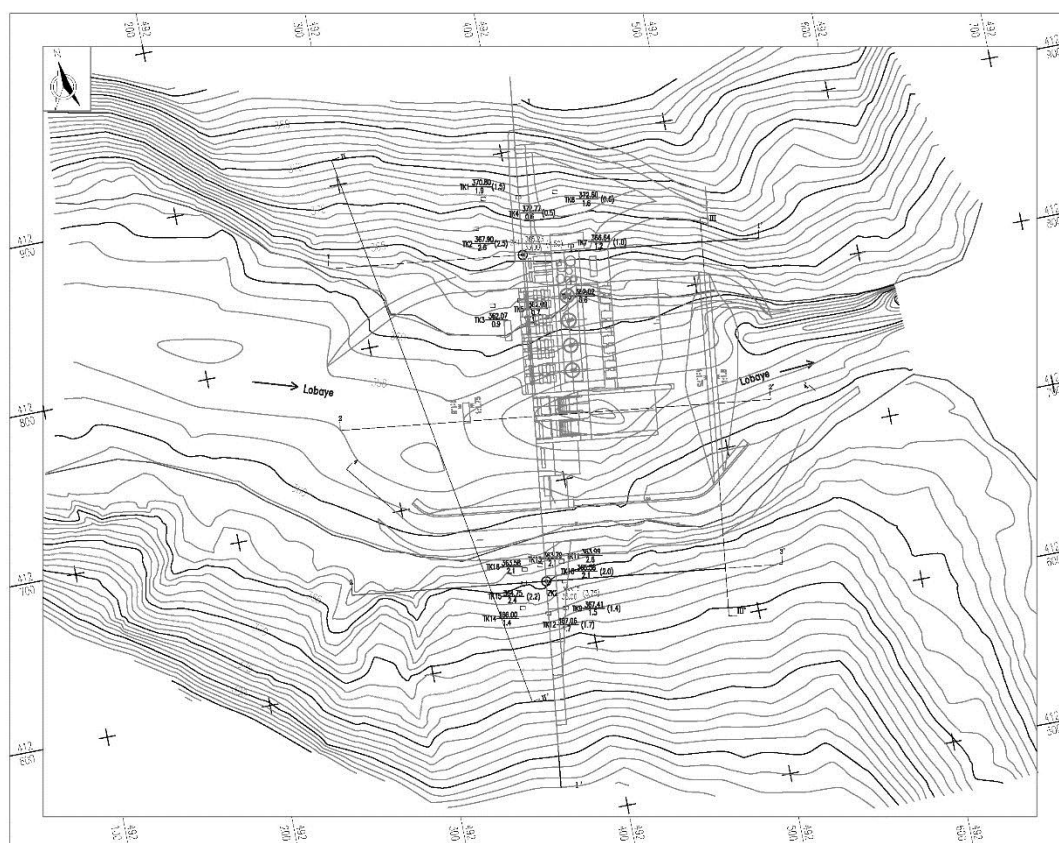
Schéma de position du plan de forage de la centrale hydro électrique de BAC
